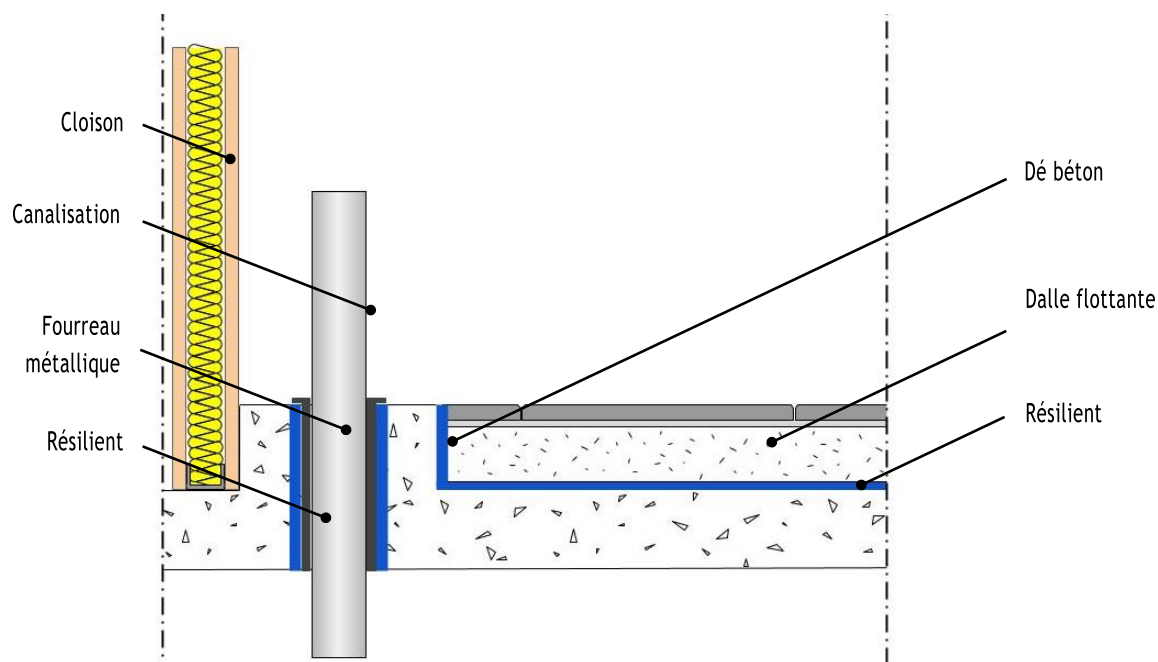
Principe de mise en œuvre des traversées de canalisations dans une dalle ou une chape flottante.
